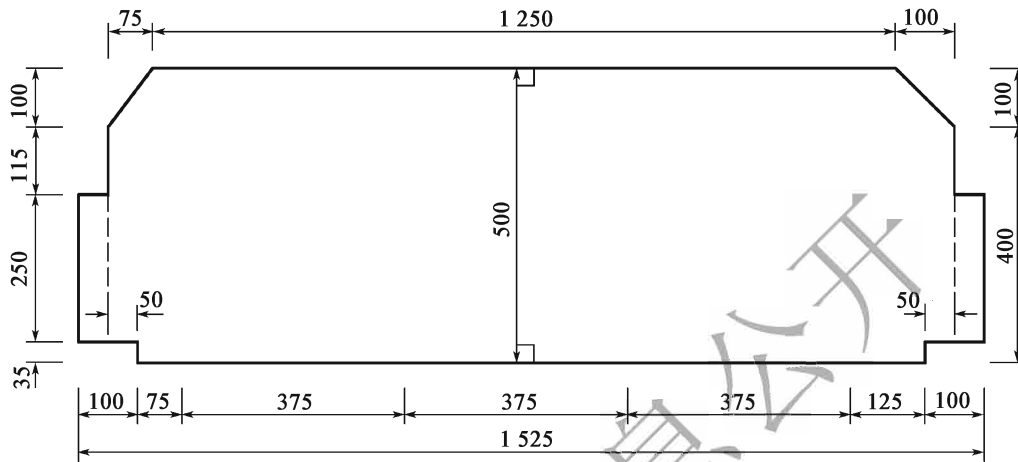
Dégagement de construction du tunnel autoroutier et du tunnel routier de première classe à trois voies(120km/h) (unité ; cm)
